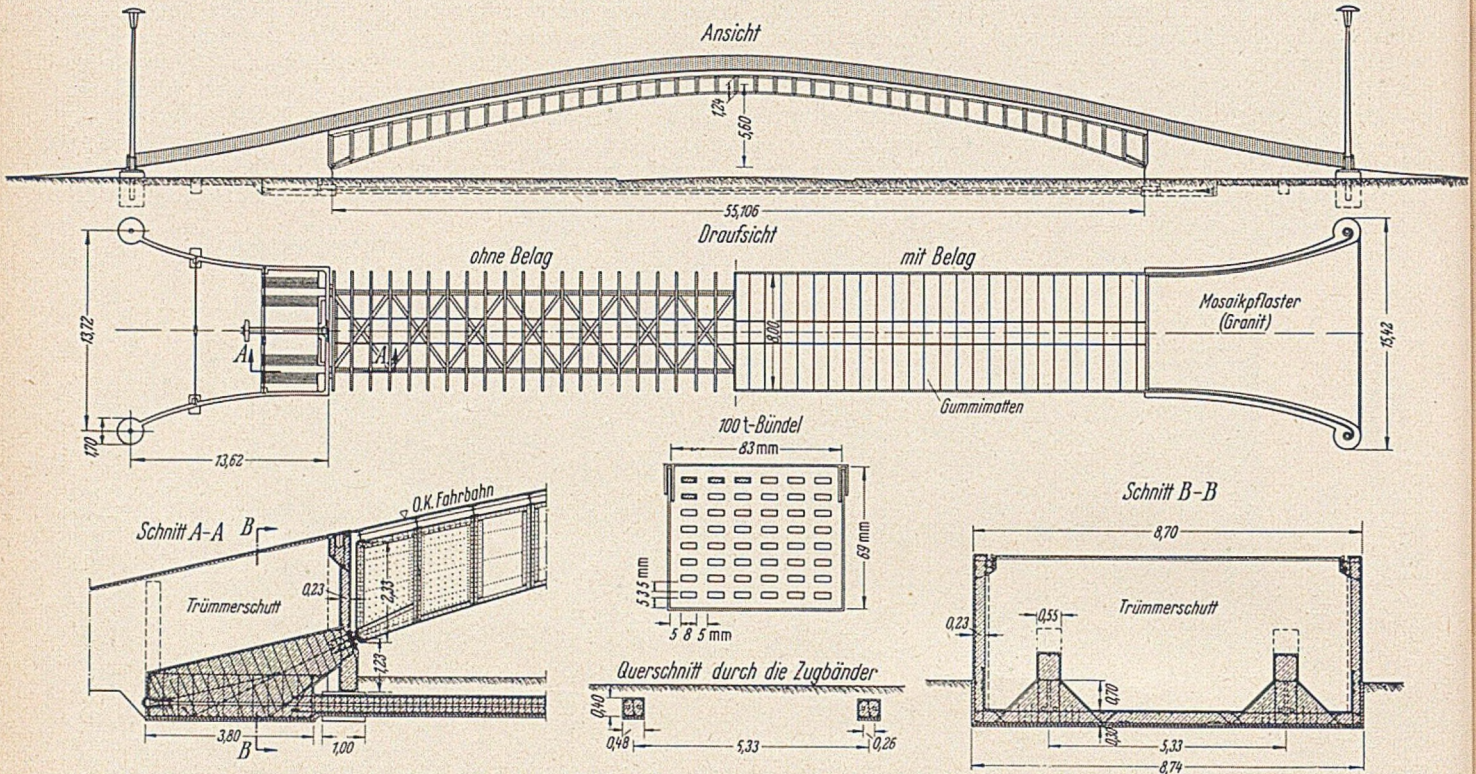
Übersichtszeichnung mit Widerlager und Zugband.
